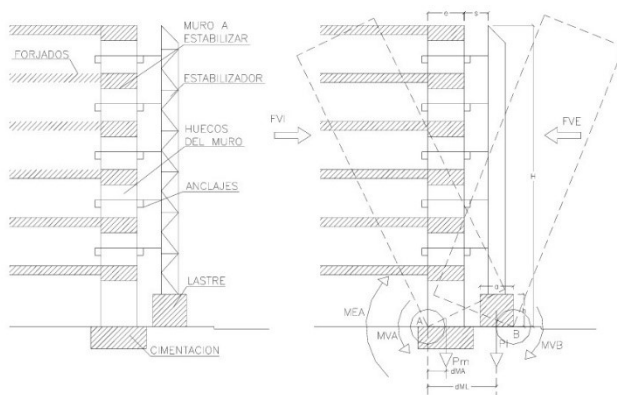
Modelo para el cálculo del lastre de un estabilizador de fachada.
